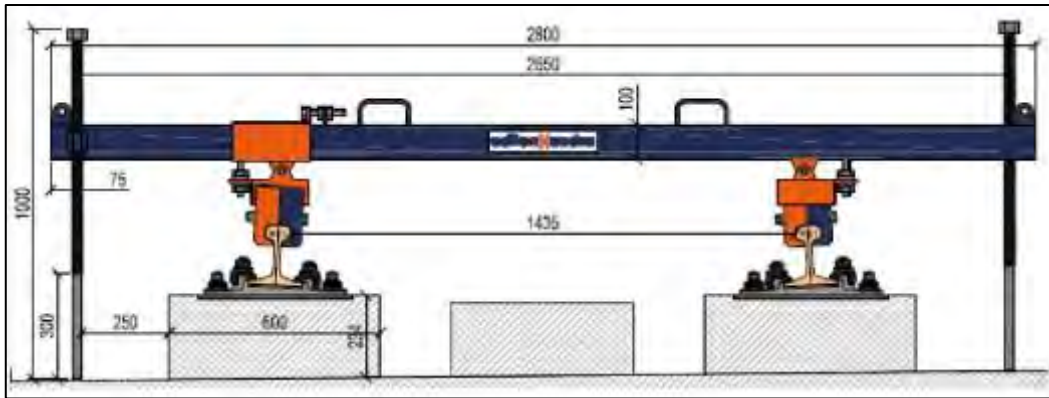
Colocación de las falsas traviesas [Traviesa Edilson Sedra]
